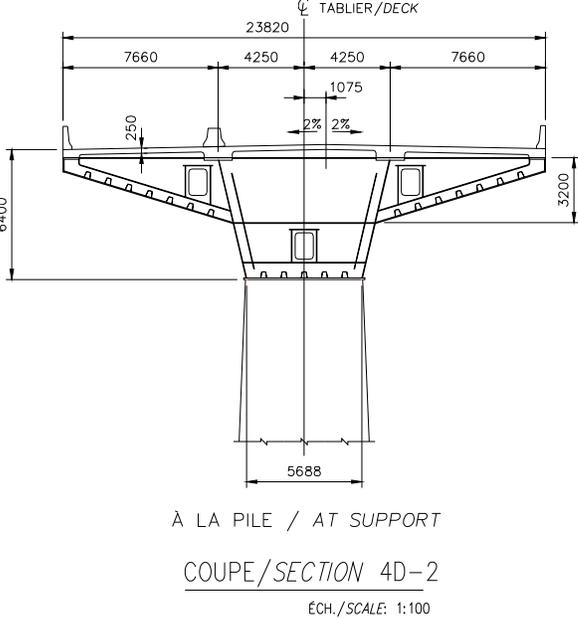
Coupe transversale – Pont en ossature mixte avec des piles en V – monocaïsson fermé
